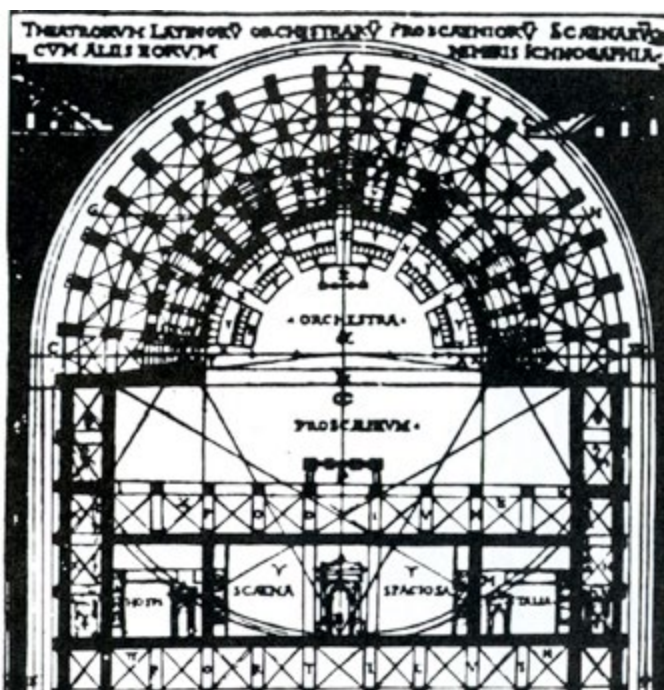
Cesare Cesariano. Planta del teatro romano de la edición de Battista Caporali al libro *De Architectura*, de Vitruvio.
